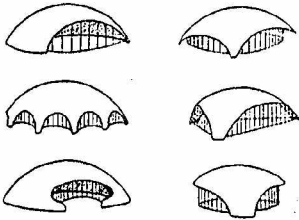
Пространственные железобетонные и висячие конструкции (схемы):
